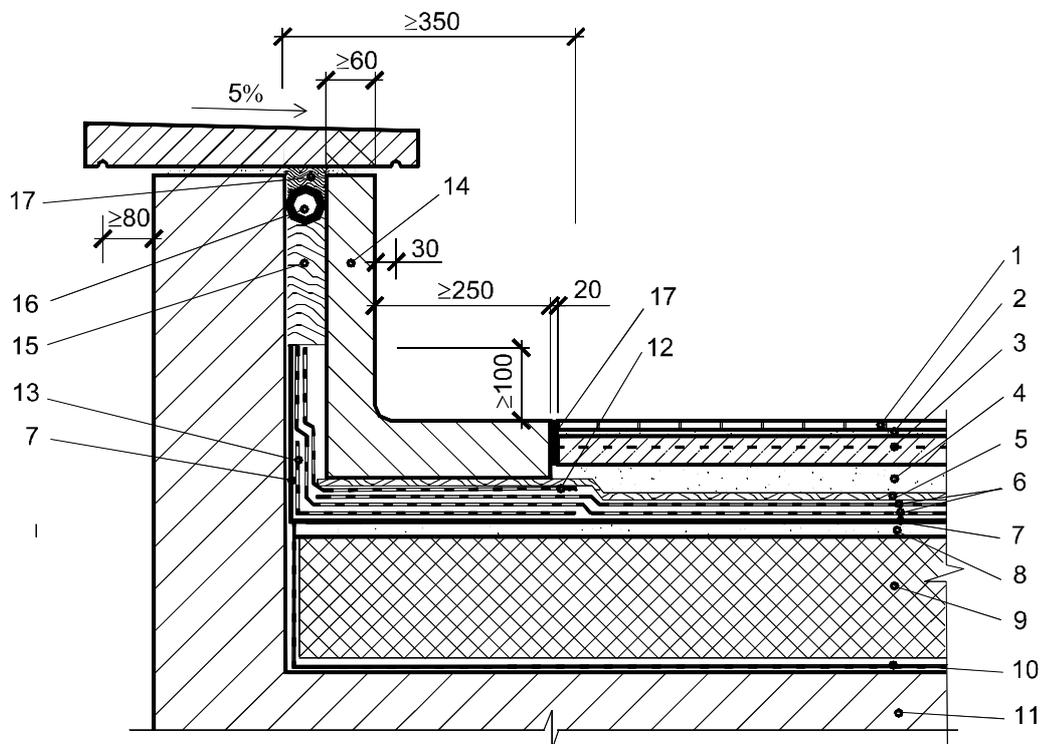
Примыкание однослойной кровли с жестким минераловатным утеплителем с самовентилиацией через примыкание
